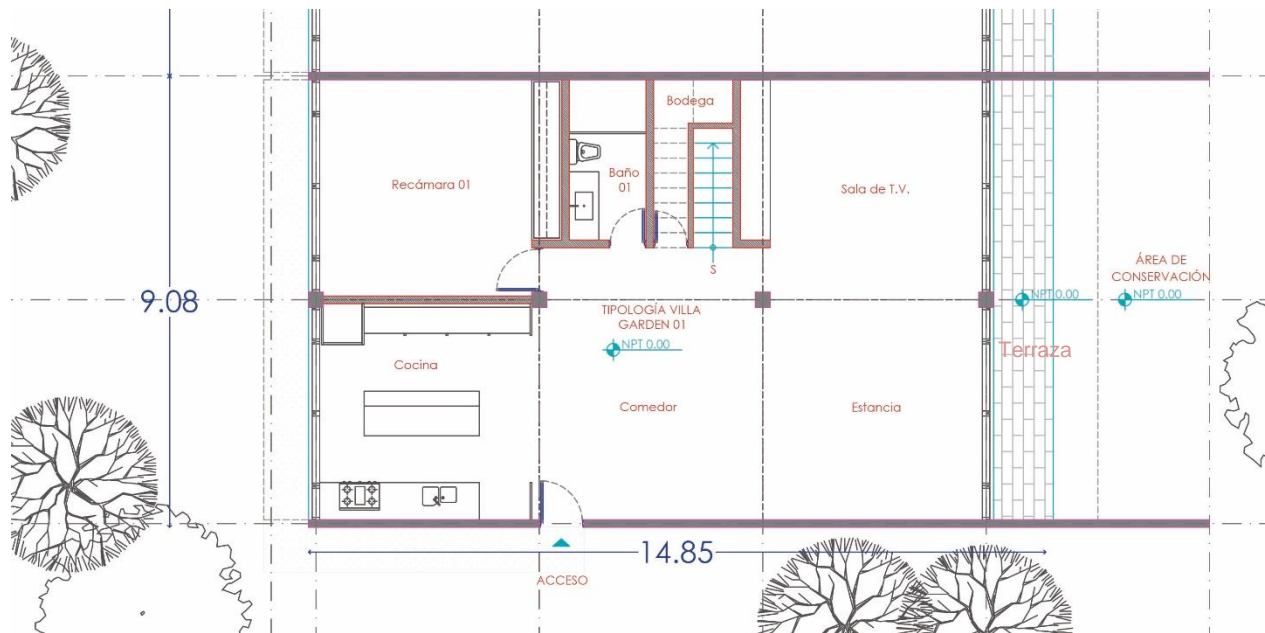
Se muestran los compartimentos de la Villa Garden Tipo 1 en planta baja.
